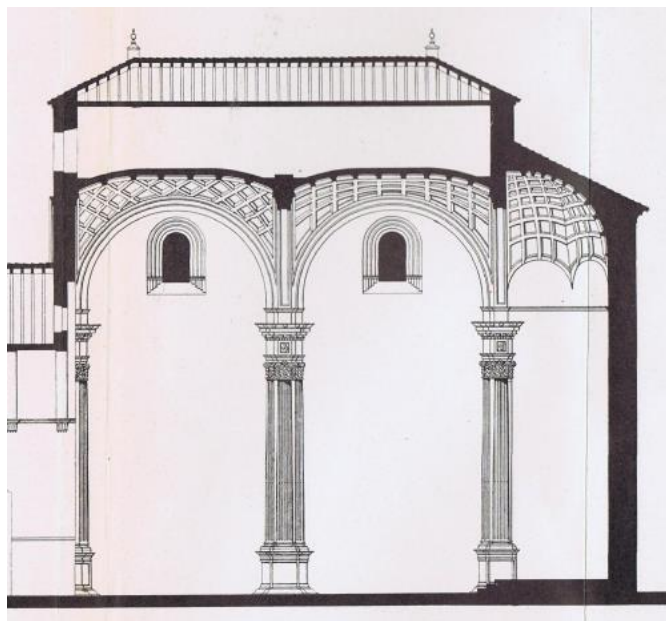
Detalle de la Sección longitudinal de la iglesia (Hernández, Sancho, y Collantes 1943, 319, dibujo 159)
